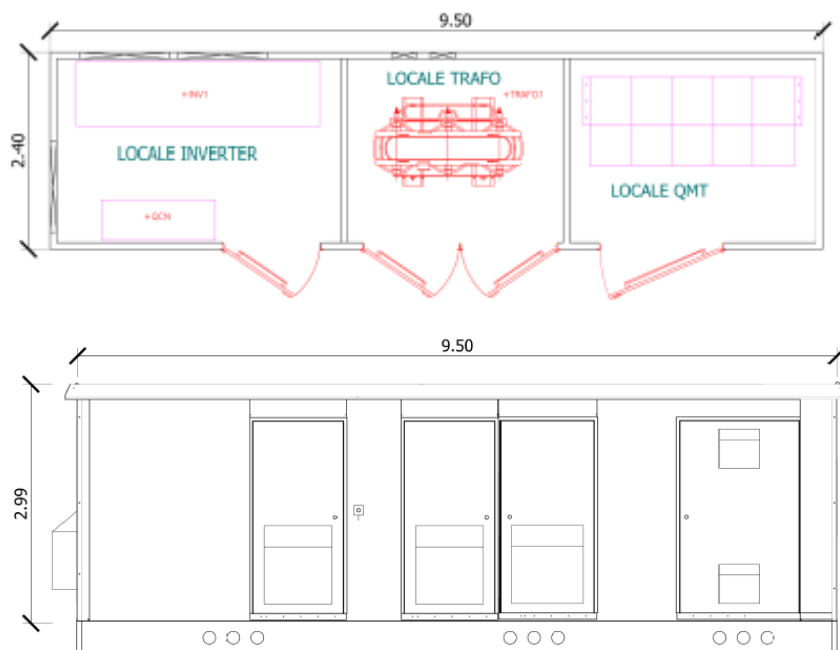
Pianta e prospetto cabina di conversione e trasformazione con un inverter
